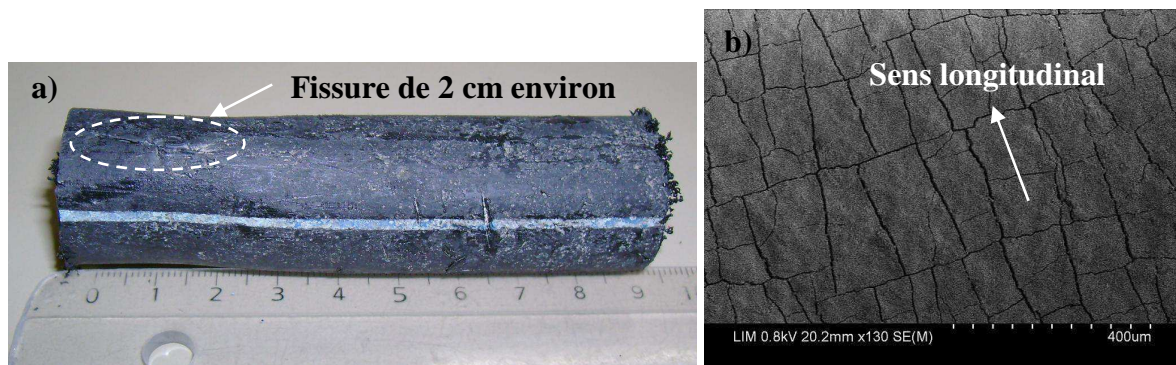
Branchement provenant d'un site exploité au chlore : a) vue globale, b) observation de la surface interne
